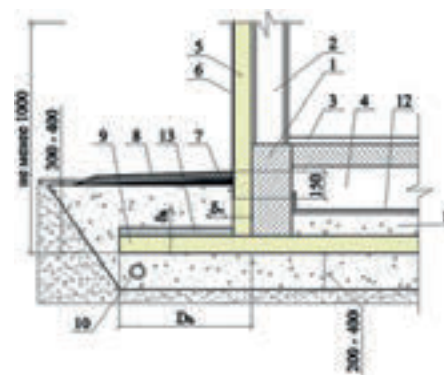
Схема укладки и параметры теплоизоляции URSA XPS в фундаментах зданий с неветилируемым подпольем и переменным режимом эксплуатации (отапливаемое – неотапливаемое)
